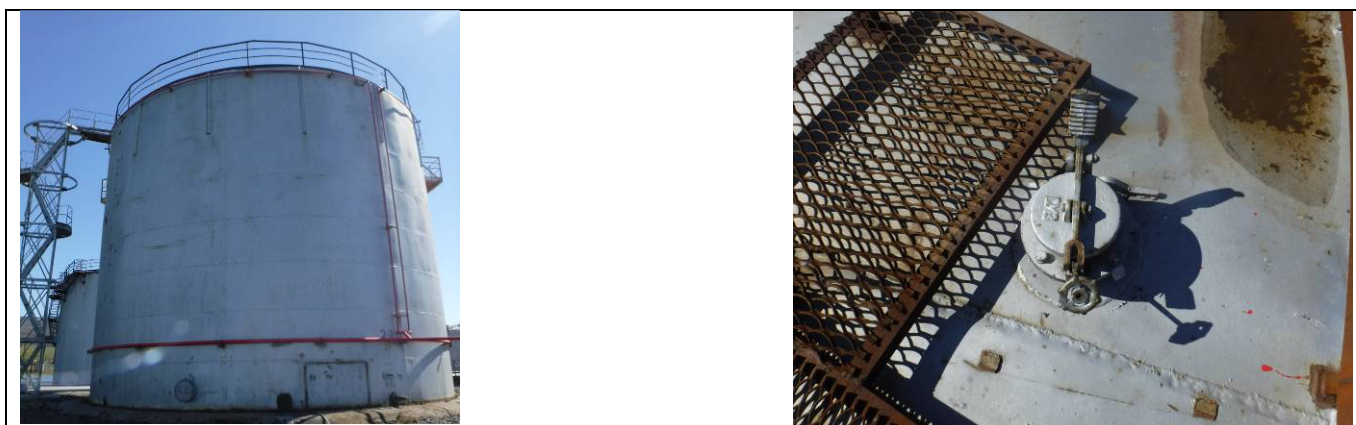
Общий вид резервуара РВС-2000 (№29) с замерным люком
